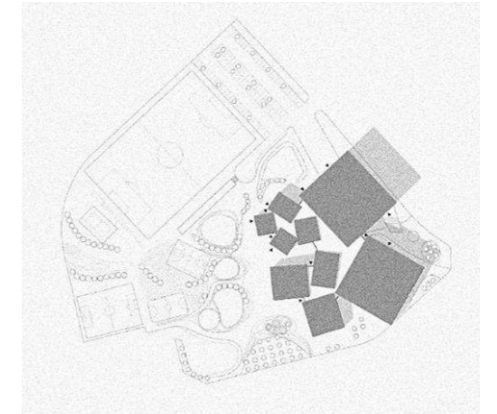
FIGURA X. PLANO EMPLAZAMIENTO 1/5000
